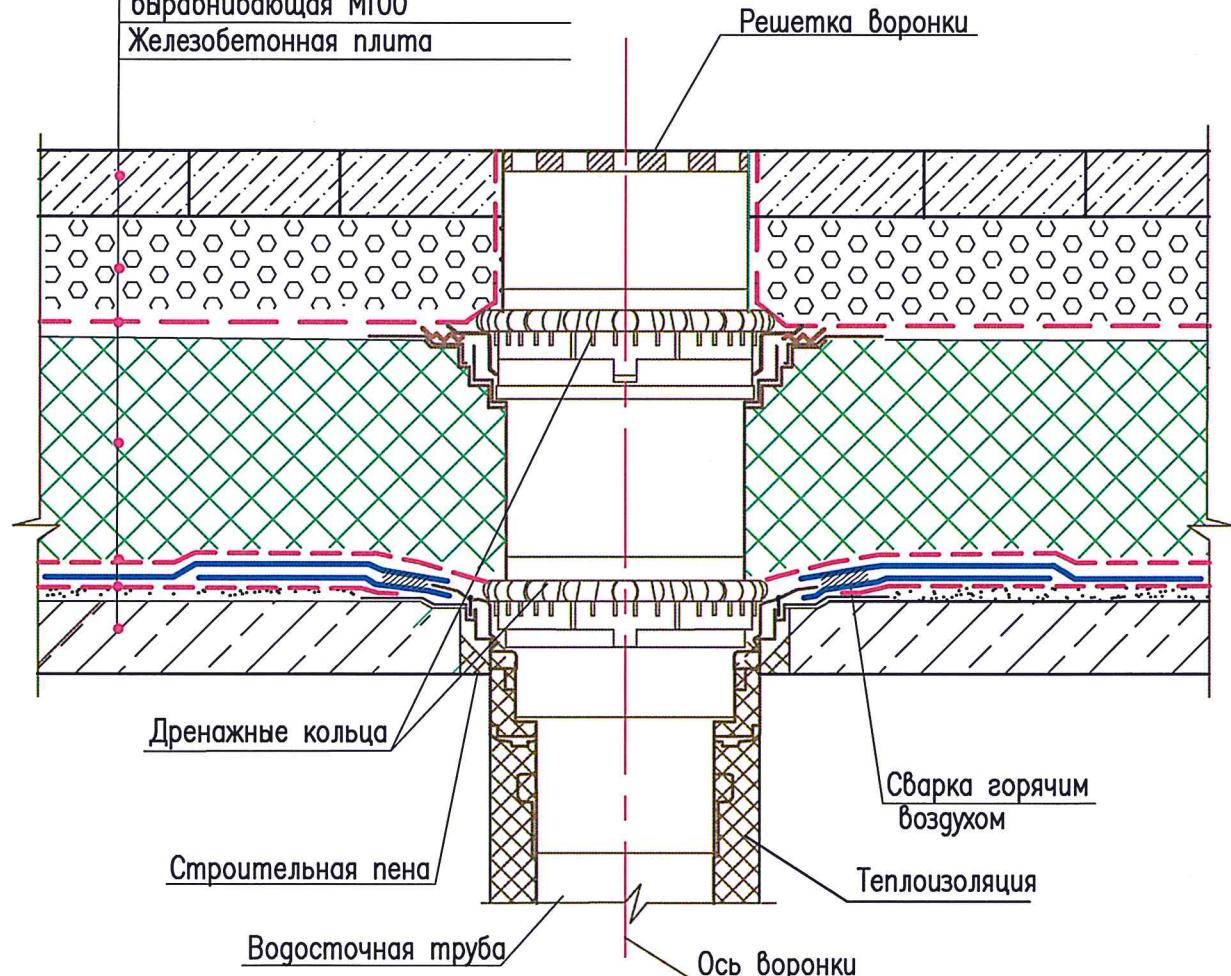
Конструктивные решения узлов для инверсионной кровли по железобетонному основанию. Устройство водосточной воронки на эксплуатируемой кровле
